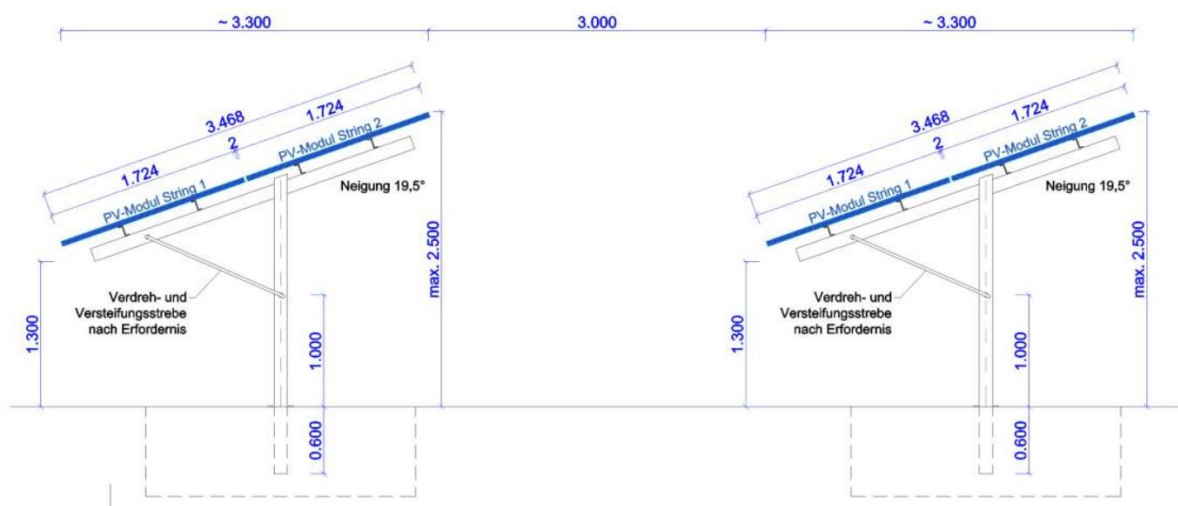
Systemschnitt (Auszug Einlage 4 Schemaplan Photovoltaikanlage EH Rainbach)
